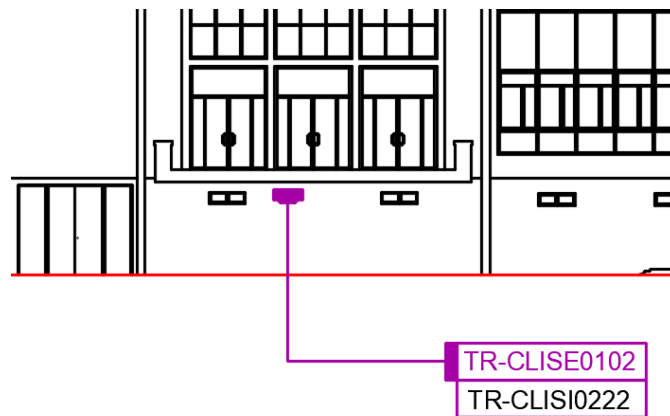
Equipo TR-CLISE0102 (Vista planos As-built)
